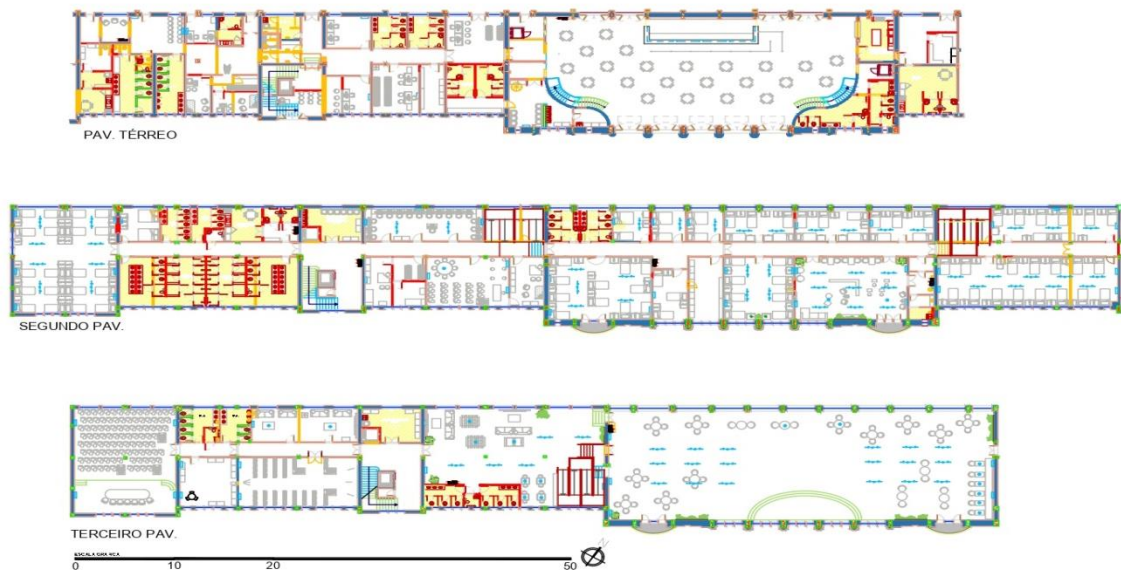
Planta baixa do Centro Pop, Térreo, Segundo e Terceiro Pavimentos (Produção da Autora).
